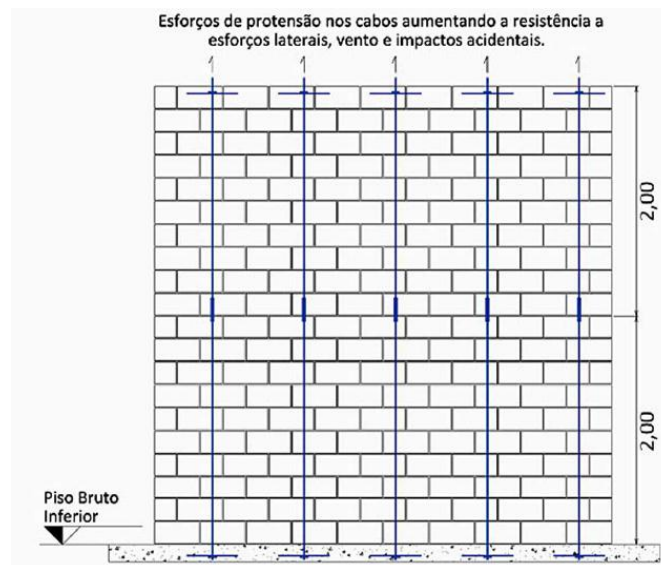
Alvenaria estrutural armada ou parcialmente armada
